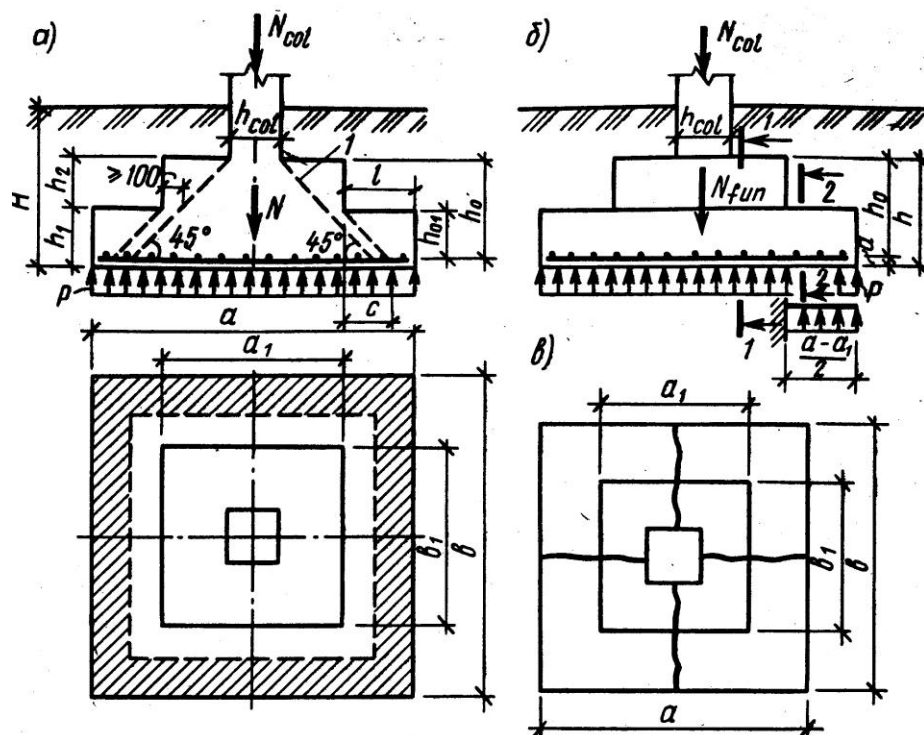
К расчету отдельных центрально нагруженных фундаментов: 1 — пирамида продавливания
